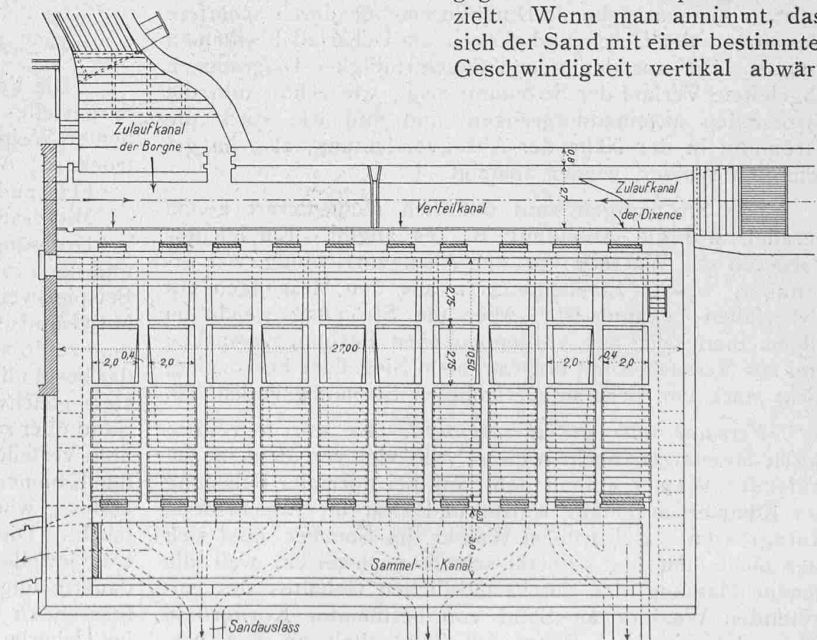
Entsandungsanlage der A. J. A. G. im Sauterot, Wallis. — Grundriss 1 : 300.
